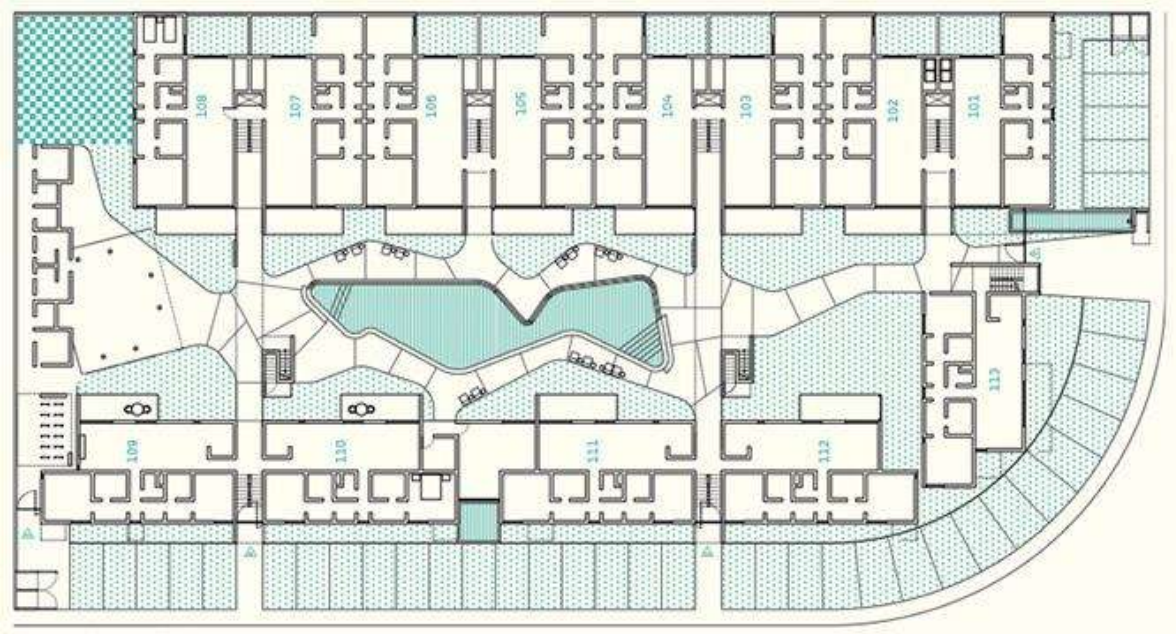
Planta baja del caso análogo “Querido Tulum” construido en el complejo privado “Aldea Zama”.
